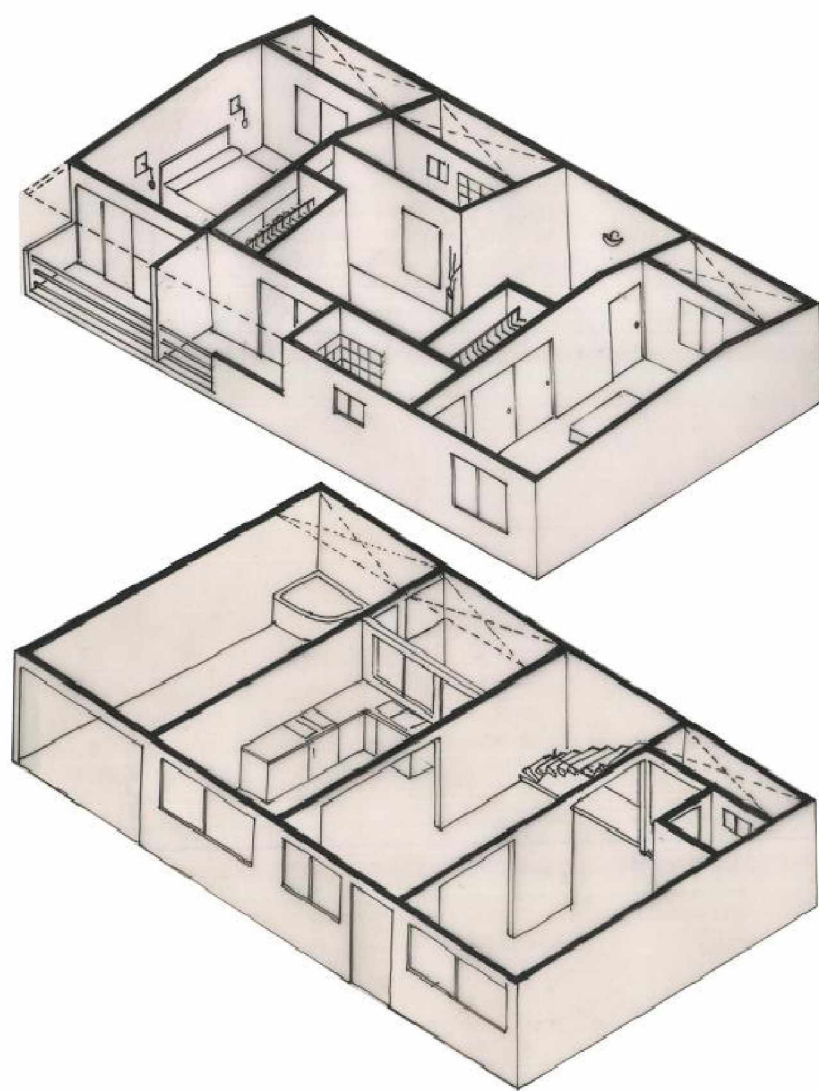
BOCETO ISOMÉTRICO DE PLANTA ALTA Y PLANTA BAJA
